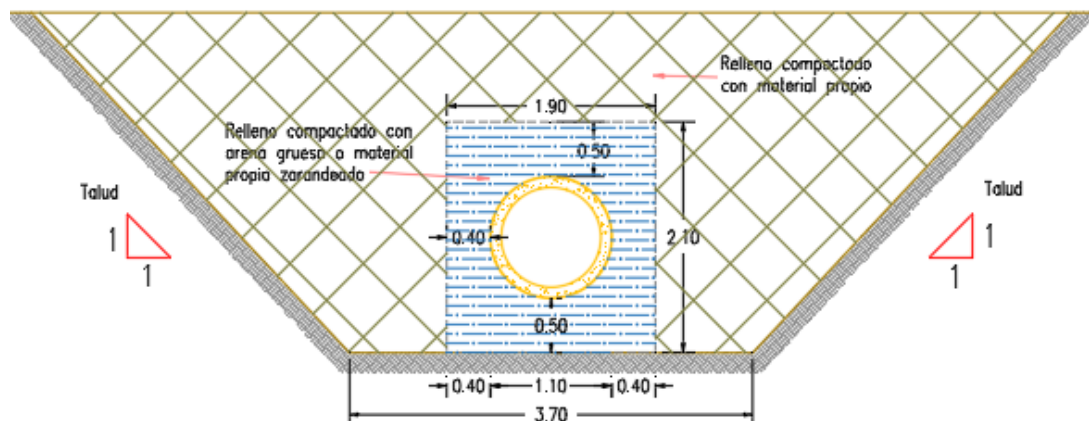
Detalle de relleno de zanja para tubería ONP.
